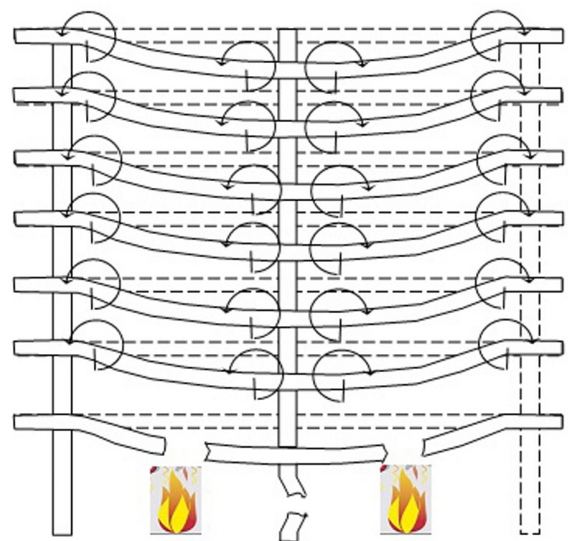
Розрахункова схема для розрахунку прогресуючого руйнування будівлі із залізобетонними конструкціями
